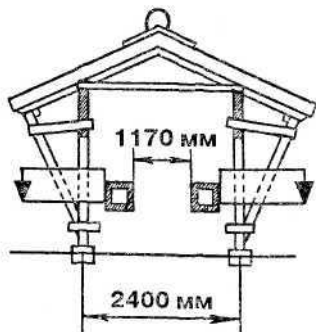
Шед из сборных железобетонных конструкций с клетками для соболей
